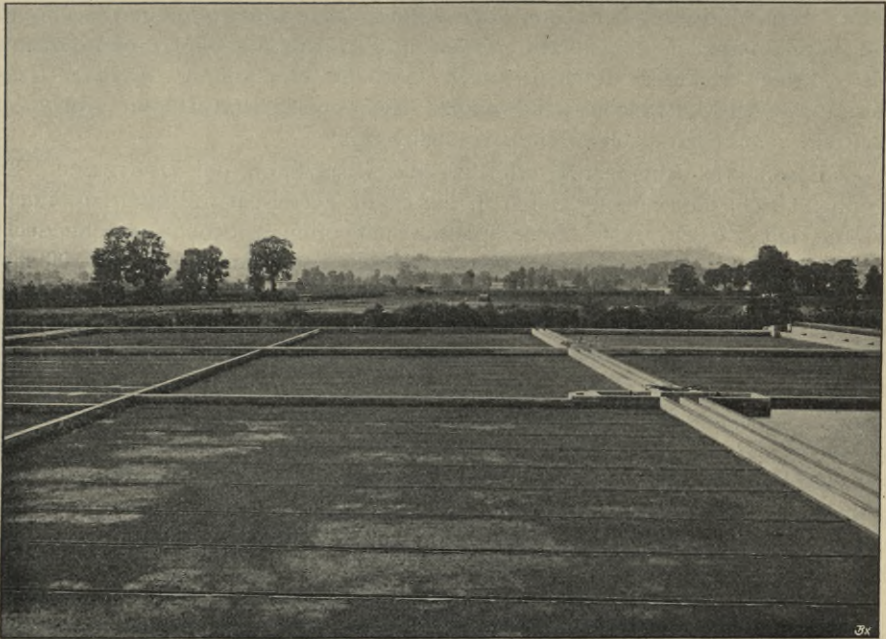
Abwasser-Reinigungsanlage von Exeter, Füllverfahren mit automatischem Betrieb.
